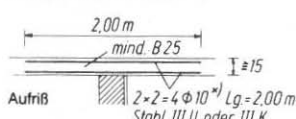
Verlegeplan für die Verdübelungsbewehrung im Bereich des Stumpfstoßes
